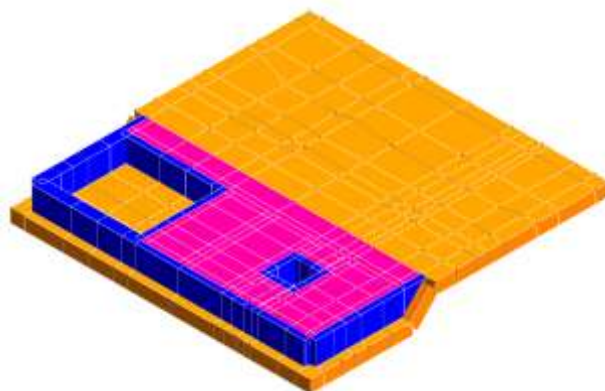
Rappresentazione delle diverse posizioni delle piastre di fondo
